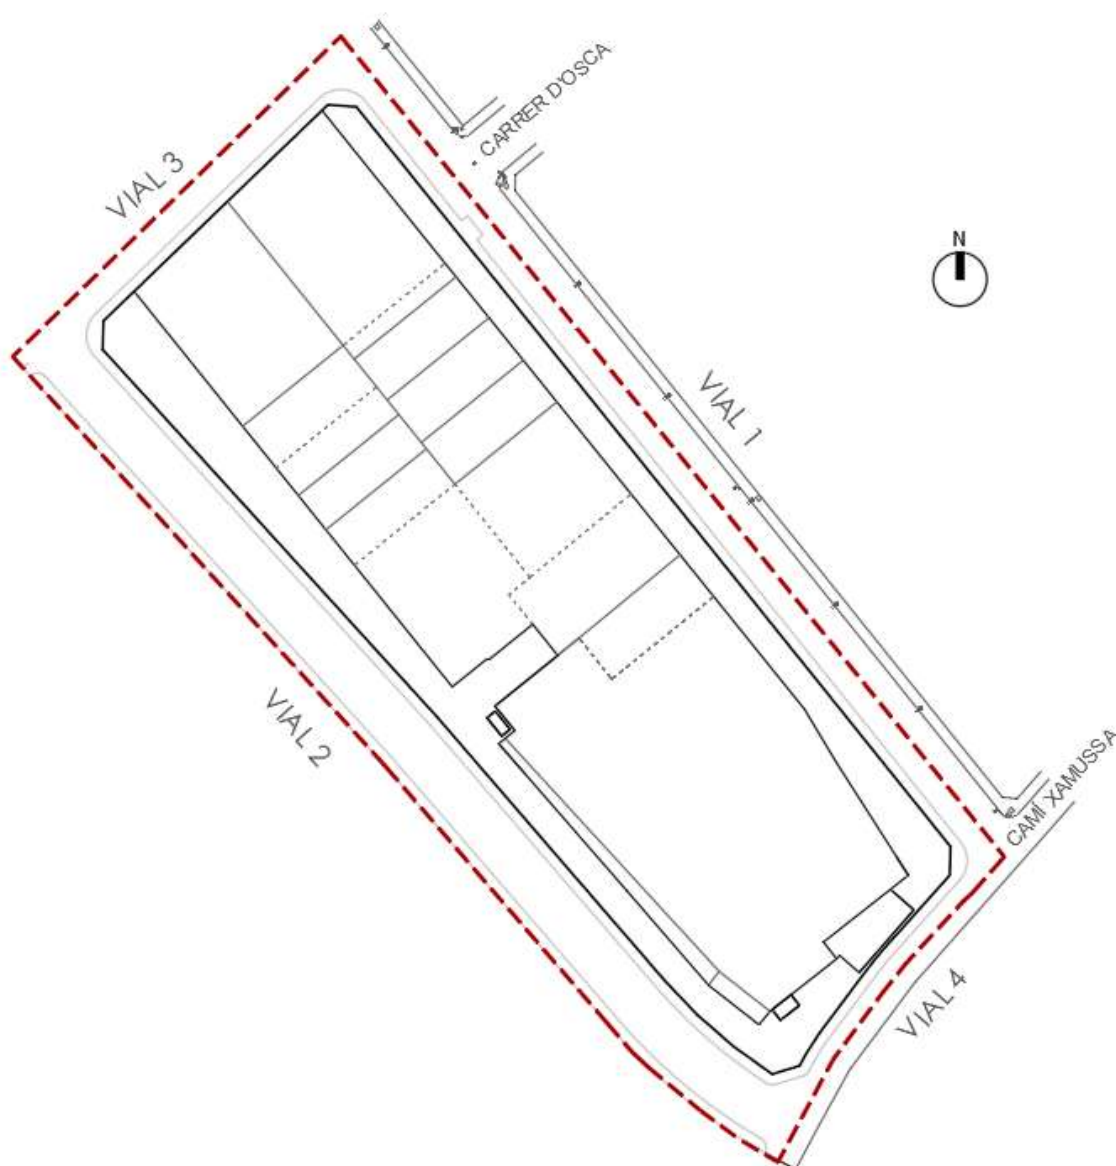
U.E. Camí Xamussa. Planta de viales.
